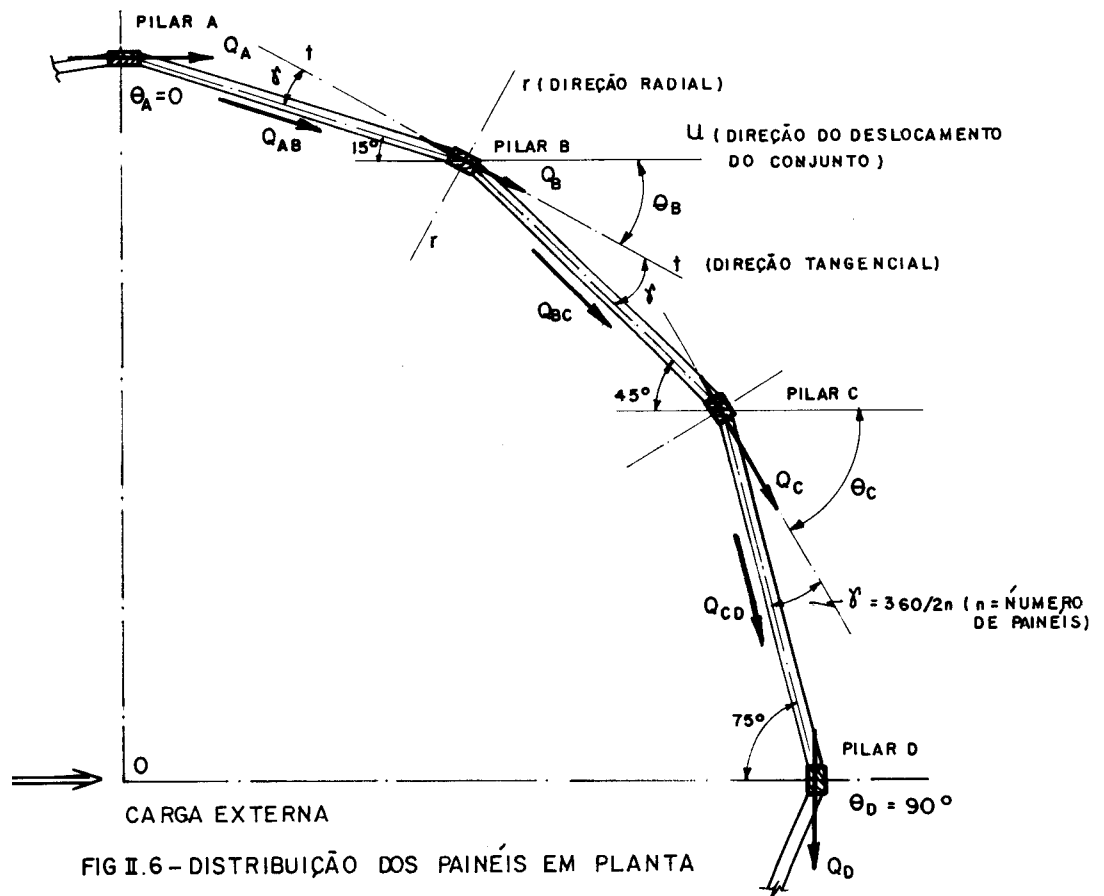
DISTRIBUIO DOS PAINIS EM PLANTA
